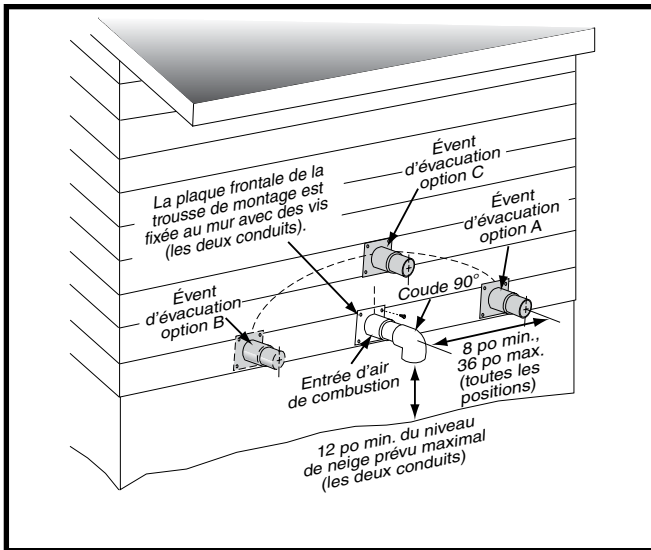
Dégagements du conduit d'admission et du conduit d'évacuation
